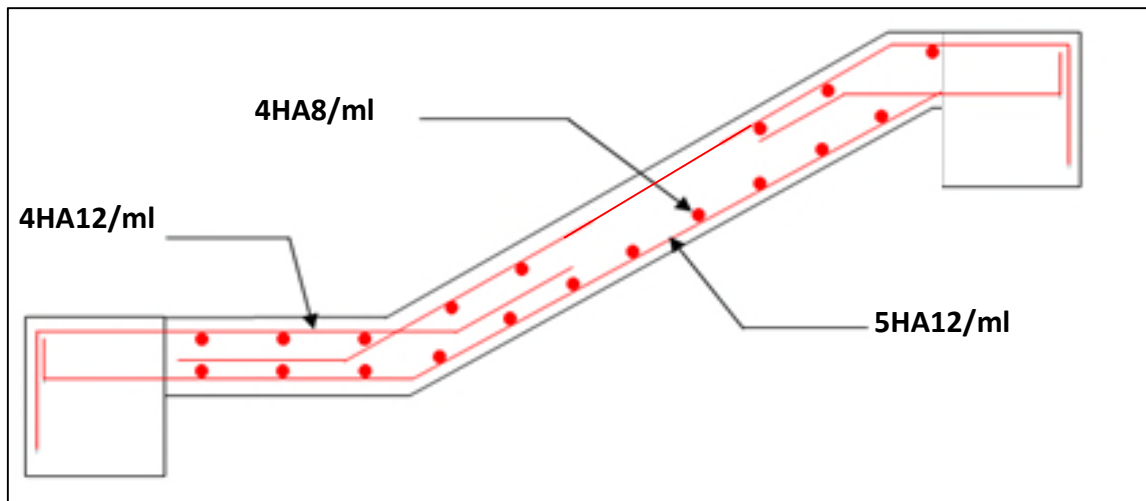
schéma de ferrailage de la partie AB de l'escalier RDC
